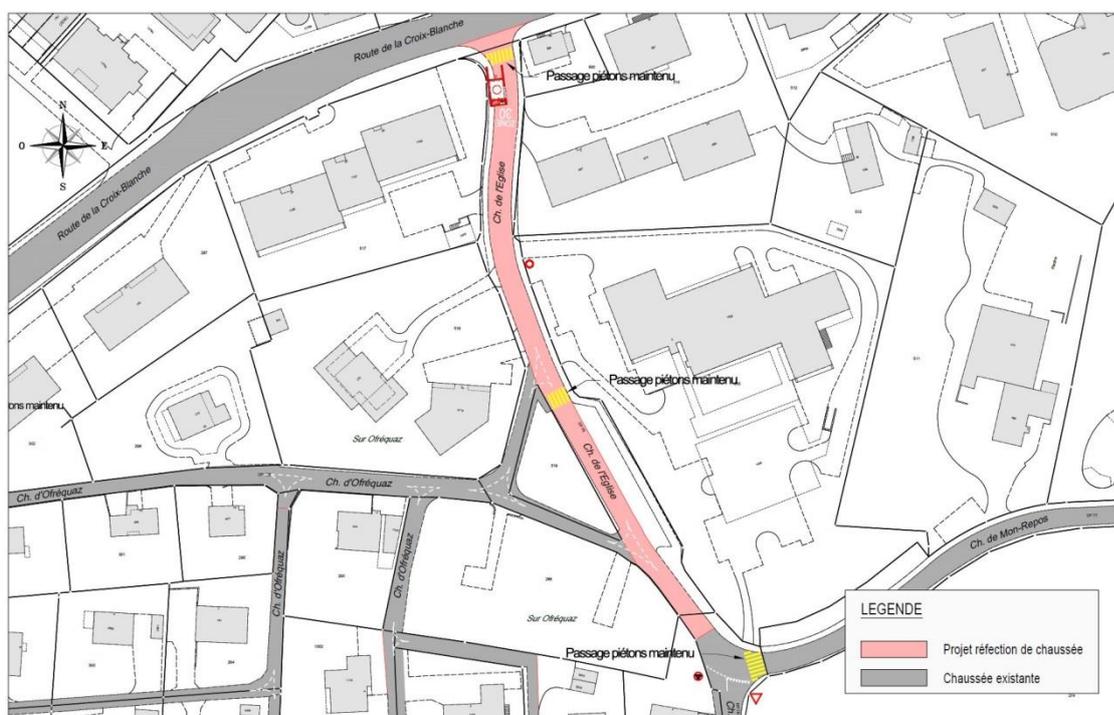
Plan des travaux sur le Ch. de l'Eglise
